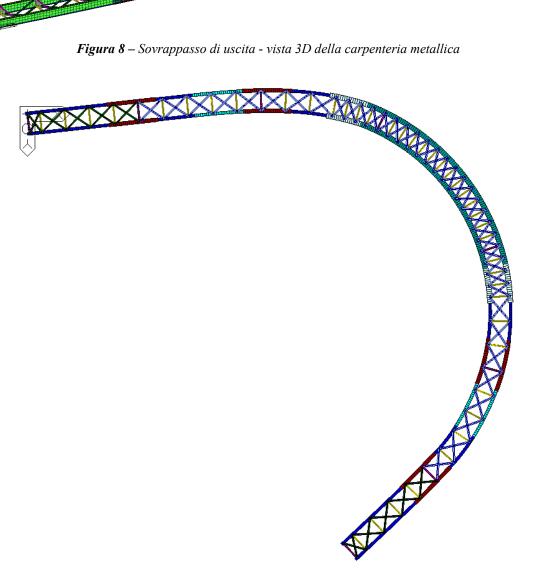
Sovrappasso di uscita - vista dal basso della carpenteria metallica
